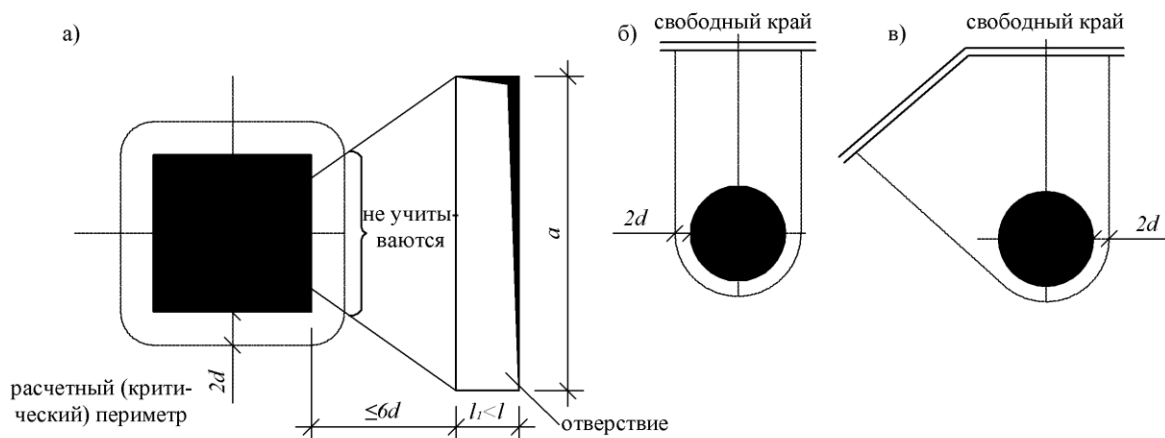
Контрольный периметр для площадей приложения нагрузки, расположенных в непосредственной близости:
